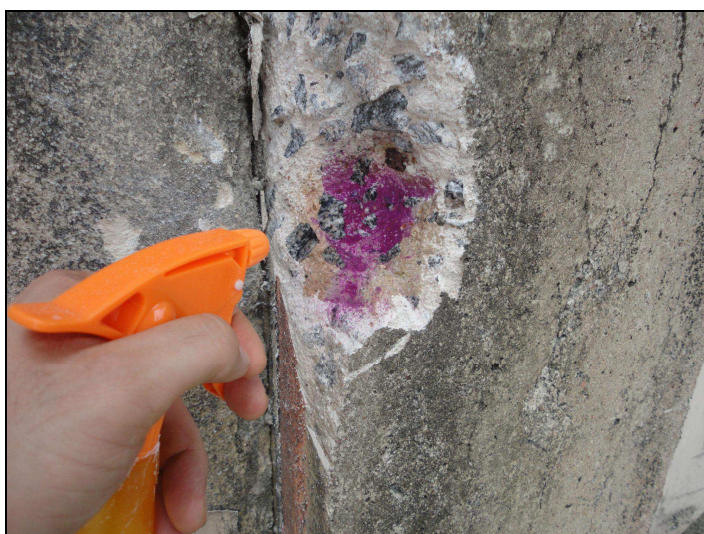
Concreto após receber a aplicação da solução de fenolftaleína.
